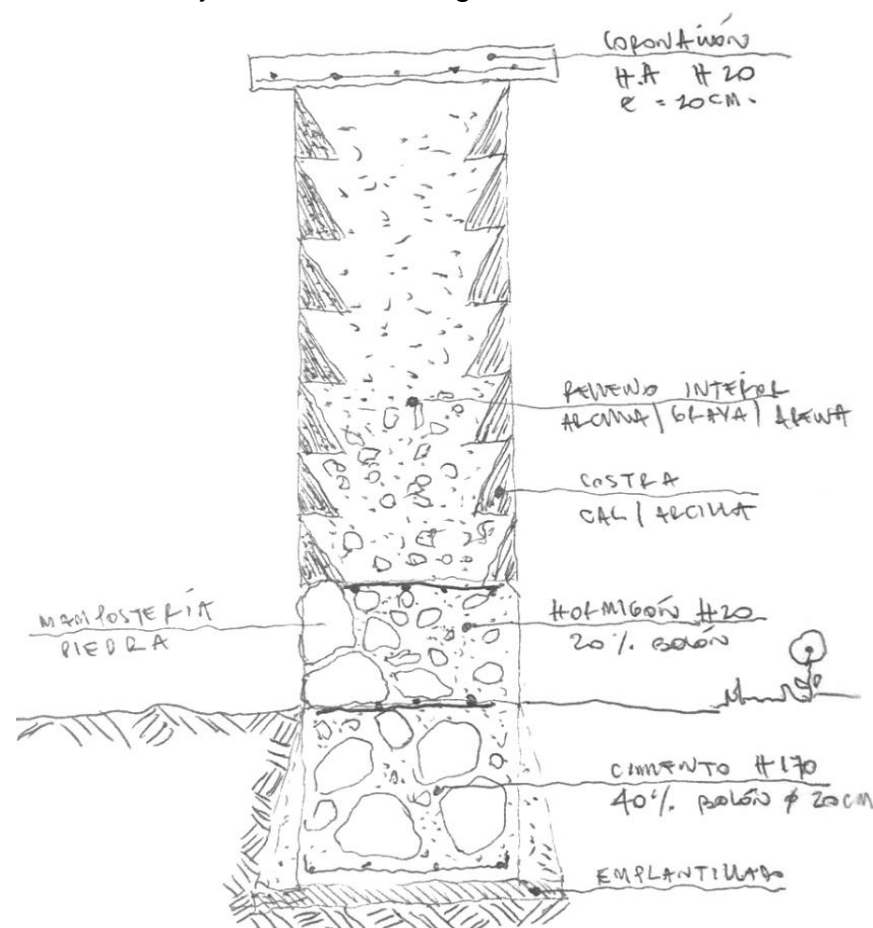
Corte constructivo de tapia calicostrada. Fuente: Colaboración de Ariel Espinola.
